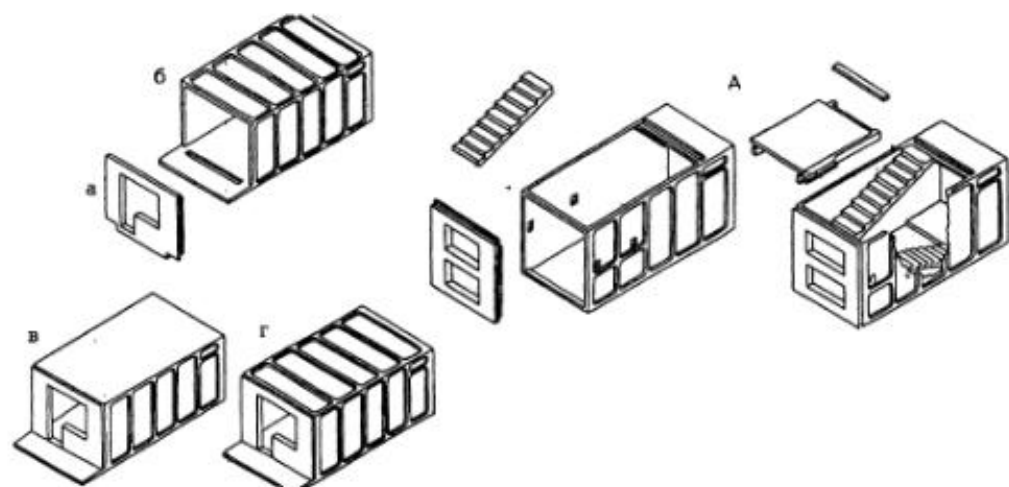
Примеры конструкций объемных блоков типа "лежащий стакан": а - приставная панель наружной стены; б - блок жилой комнаты с балконной плитой до комплектации; в - блок жилой комнаты с гладкой плитой потолка; г - то же, с ребристой; д - блок лестничной клетки до сборки и в скомплектованном состоянии (комплектуемые в него изделия: лестничный марш, промежуточная лестничная площадка, панель наружной стены)
